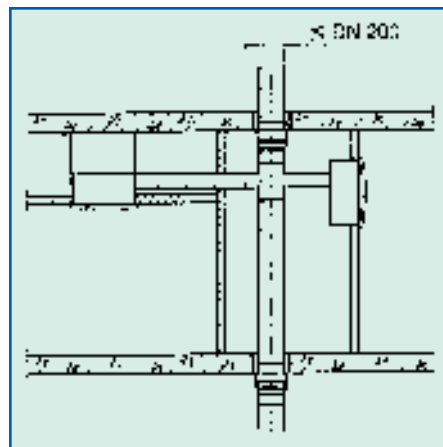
Einbausituation Einzelentlüftungsanlage mit Brandschutz-Deckenschott
